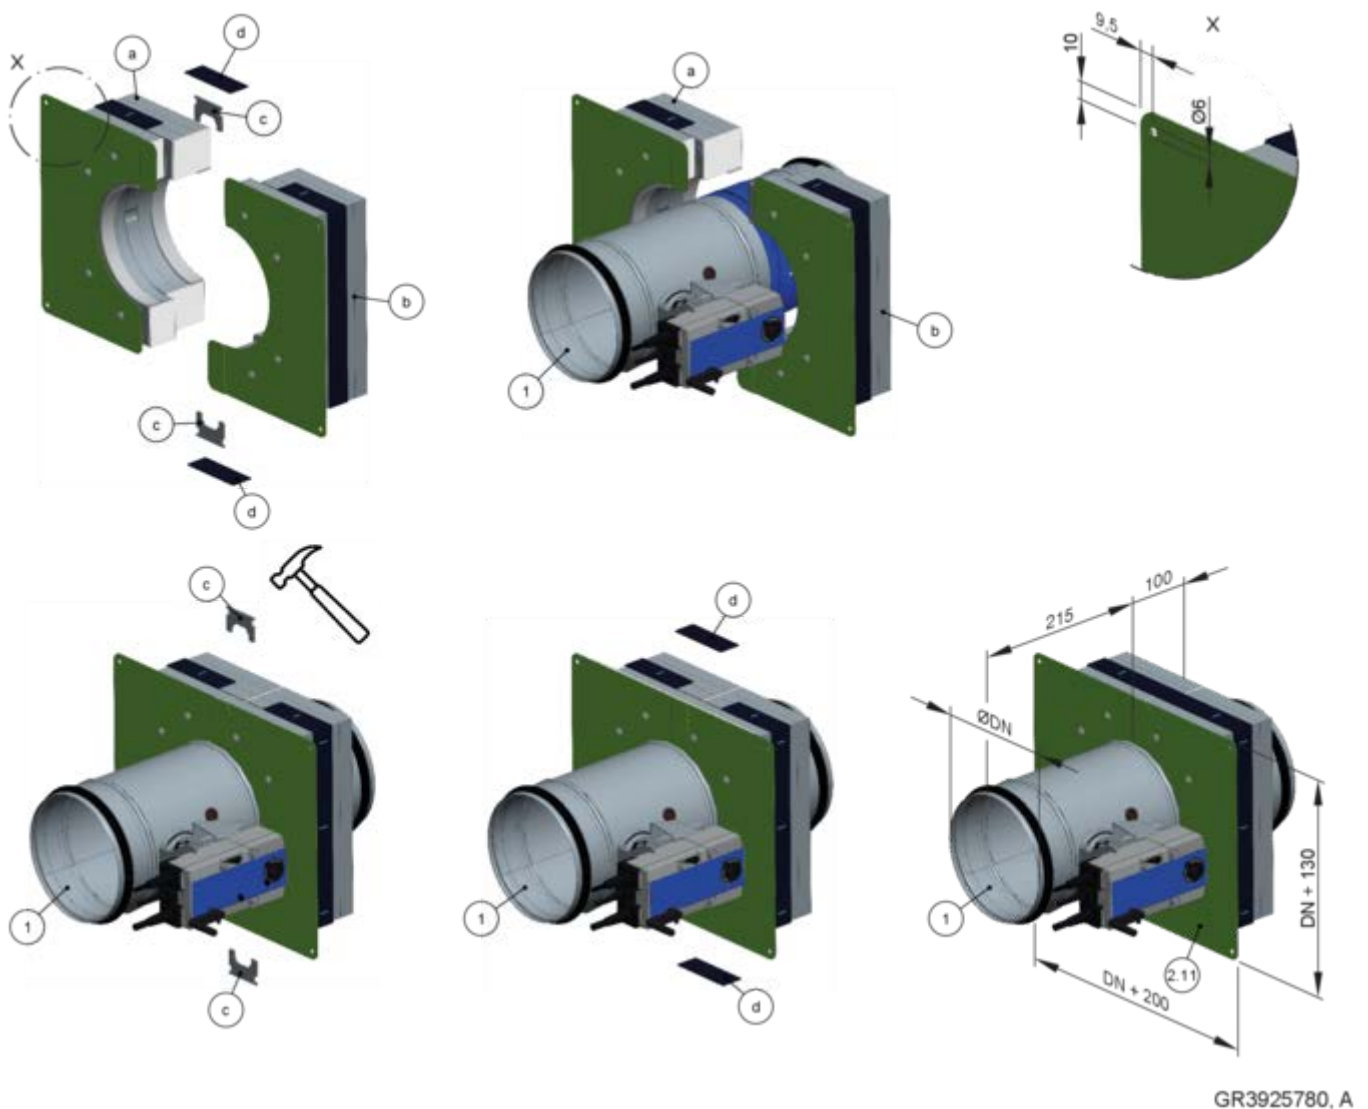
Leveranspaket och installation av installationskit TQ2 för torr installation utan murbruk
